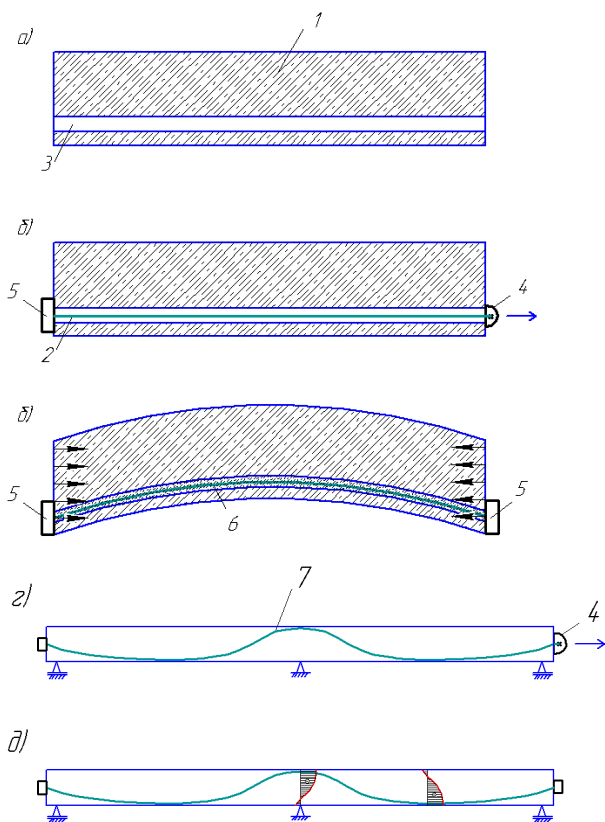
Изготовление предварительно напряженных конструкций с натяжением арматуры на бетон: *а* – бетонная балка с каналами для натягаемой арматуры; *б* – высокопрочная арматура помещена в канал и натягивается гидравлическим домкратом; *в* – бетон обжат, арматура заанкерена, канал инъецирован раствором; *г* – арматурный канат в пластиковой оболочке уложен по эпюре изгибающих моментов и балка забетонирована; *д* – арматура натянута и зоны бетона, работающие от внешней нагрузки на растяжение получили сжимающие напряжения; 1 – затвердевший бетон; 2 – натягаемая арматура; 3 – прямолинейный канал; 4 – гидравлический домкрат; 5 – концевые анкера; 6 – инъецированный раствором канал; 7 – арматурные канаты в пластиковой оболочке
